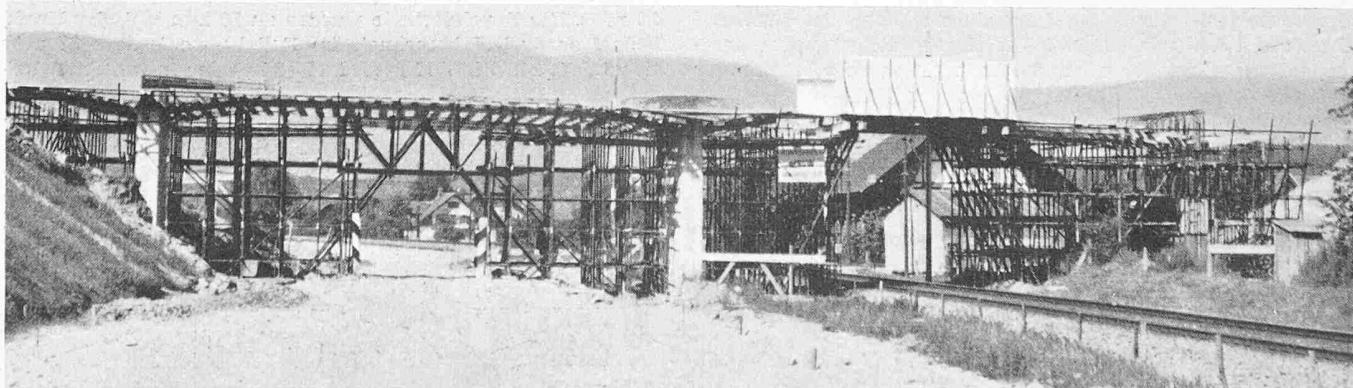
Lehrgerüst für Eisenbahn- und Strassenüberführung Studen-Biel
